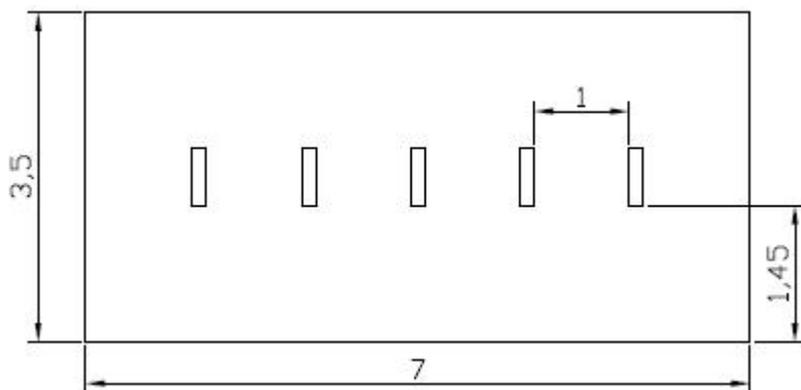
Distribución en planta de las luminarias de la habitación 5.
